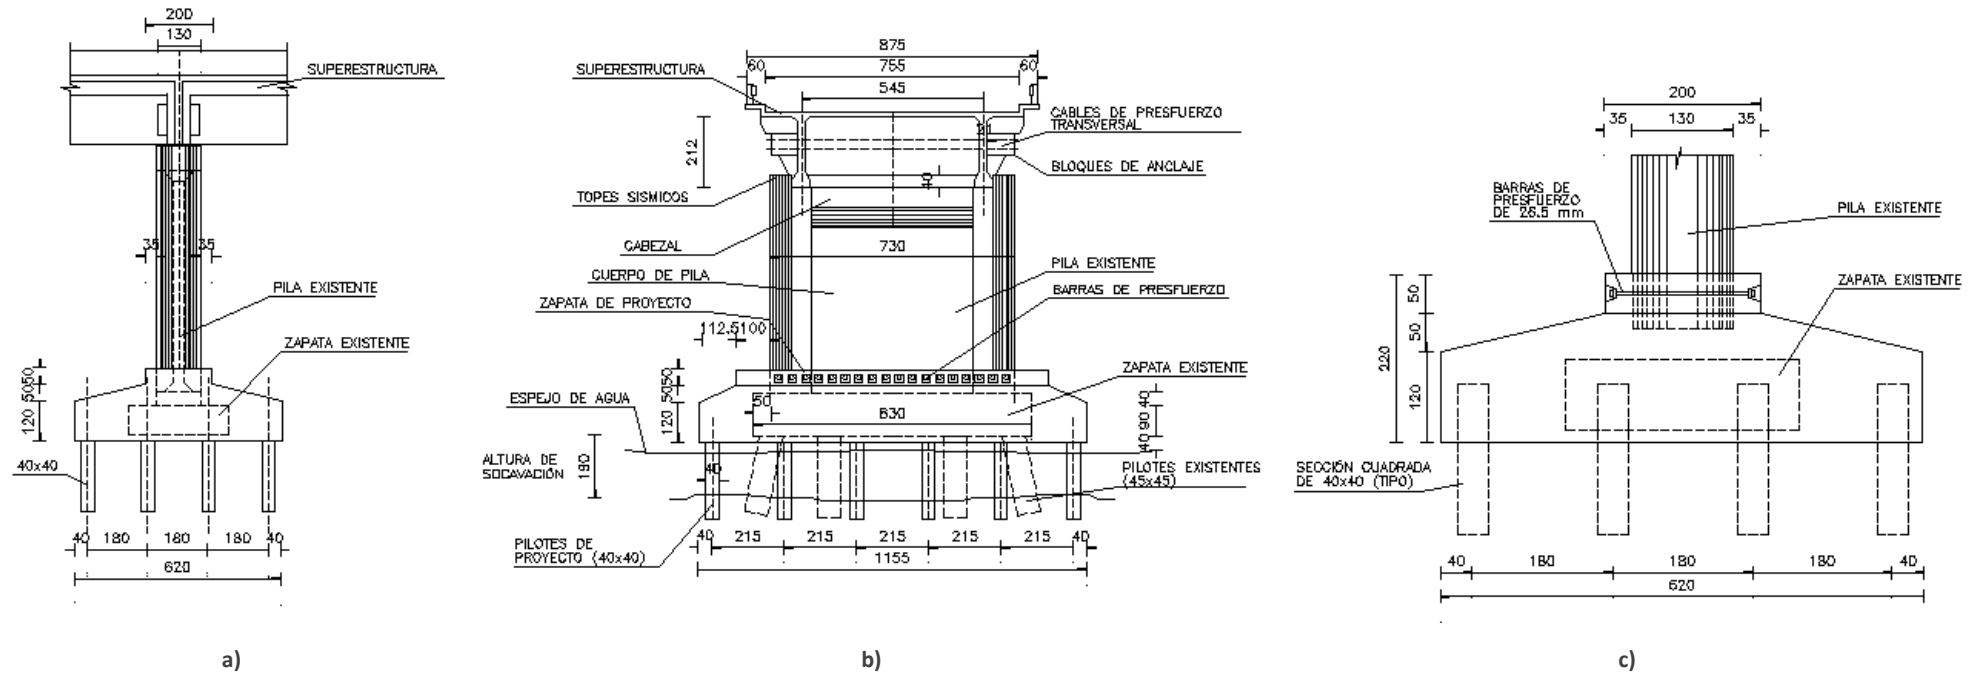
Detalle de pila central del puente Coahuayana: a) Elevación lateral; b) Elevación frontal y; c) Reconstrucción de cimentación. (Sin escala, cotas en cm).
